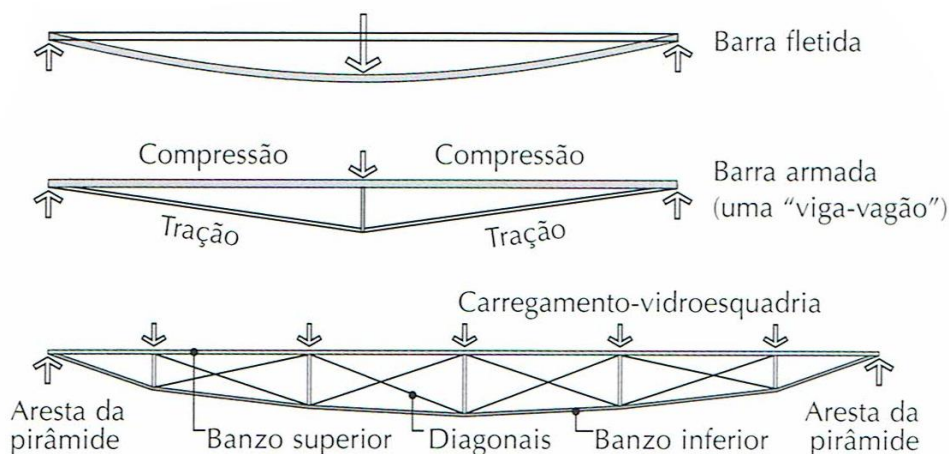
Diferenças entre os modelos estruturais de viga simples, viga vagão e treliça [5].
